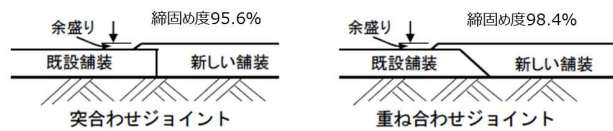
施工ジョイントの形式(空港土木施設施工要領に加筆)
